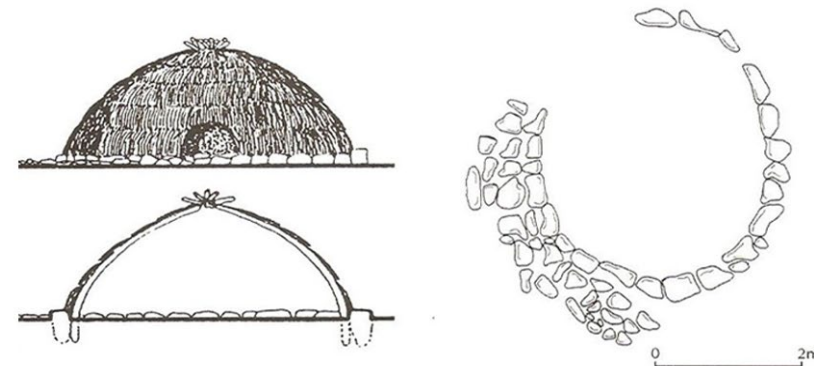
Elevación, Corte y planta esquemática de Hare 'oka. Fuente: Cristino, Vargas, Izaurieta, 2006
